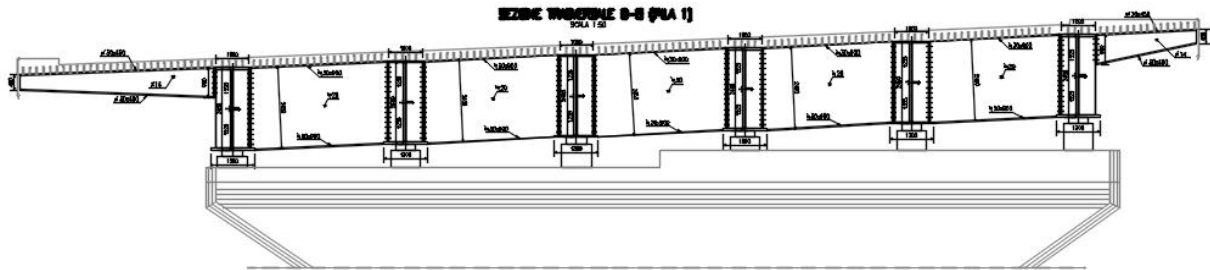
Struttura impalcato - Sezione trasversale pila P1
